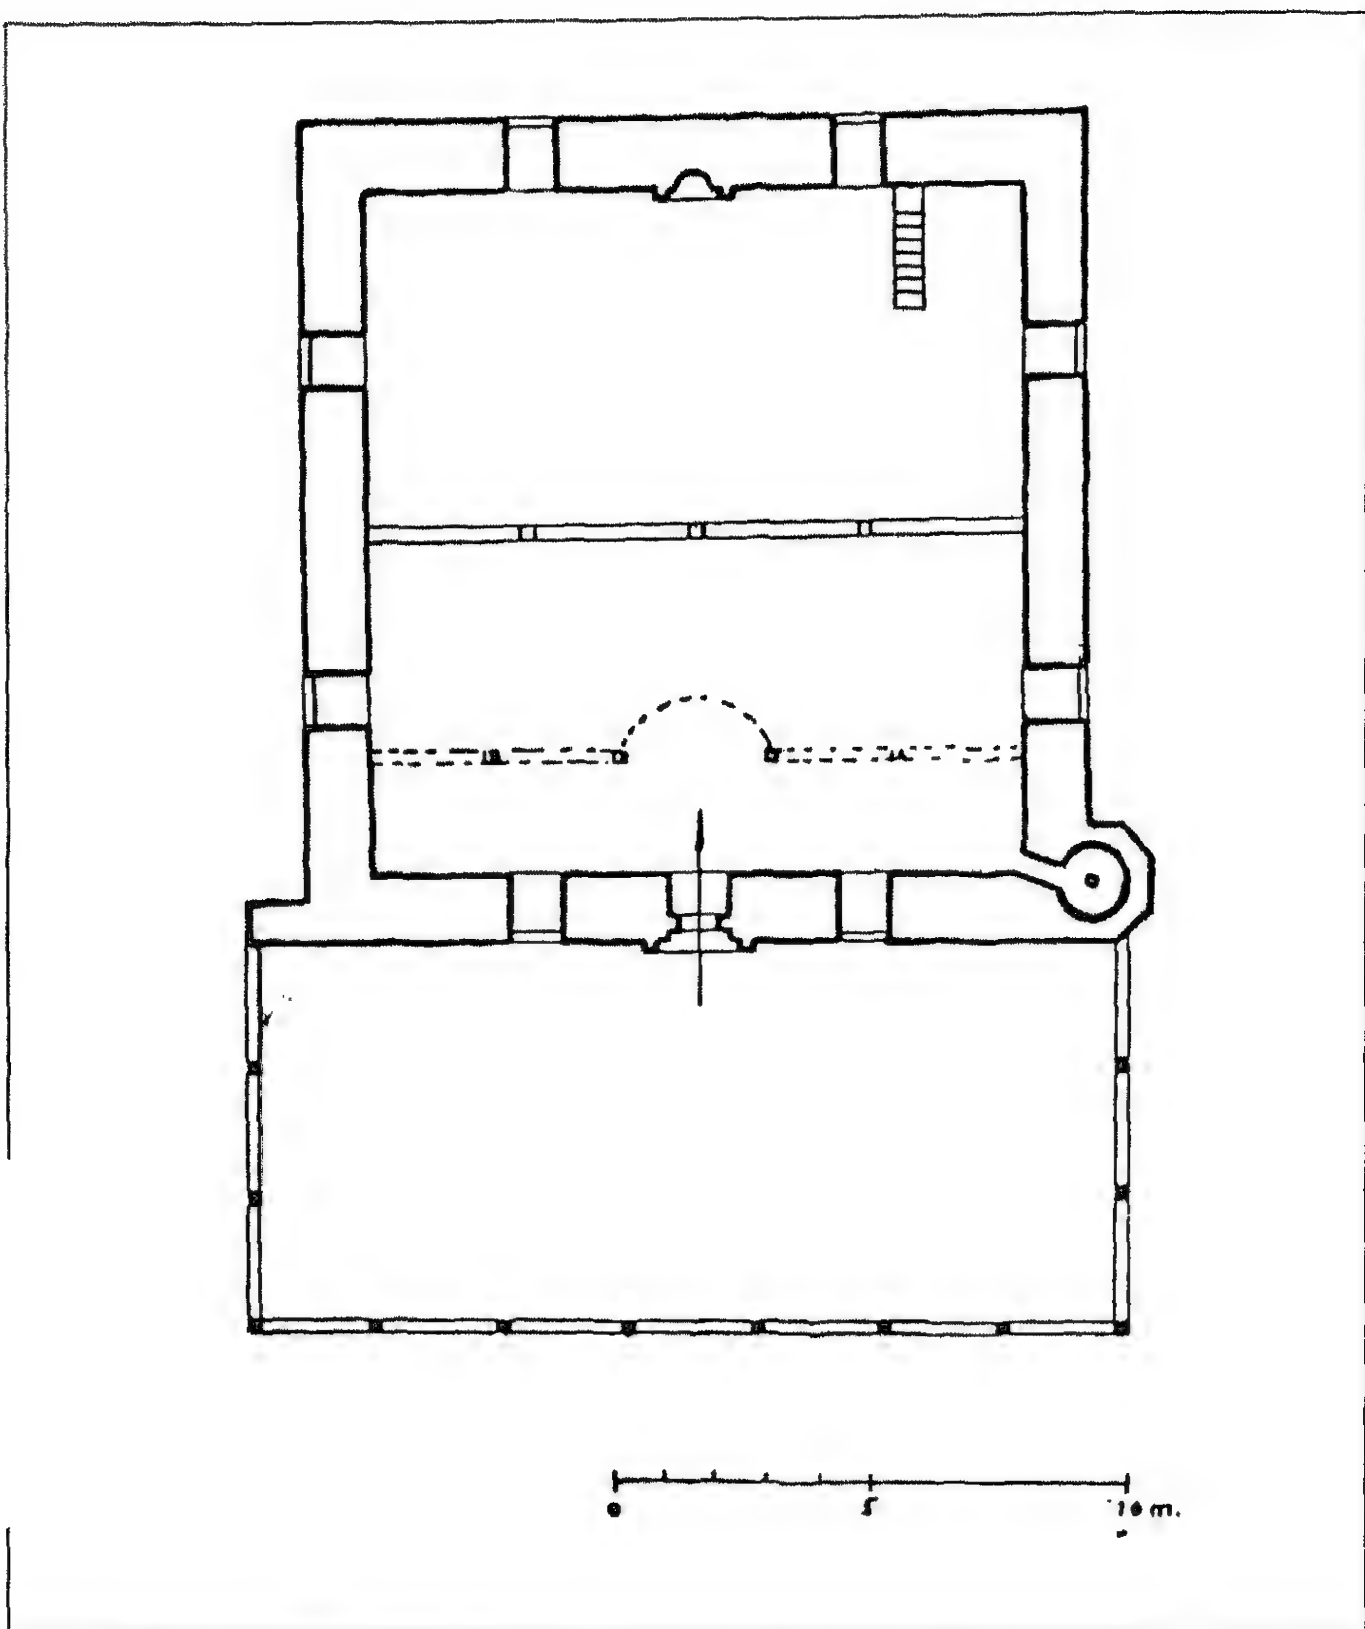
مسقط أفقي لمسجد سوكلكو محمد باشا المعروف بمسجد باب العزب (عزب قاي) بإستانبول (عن : كوران)
